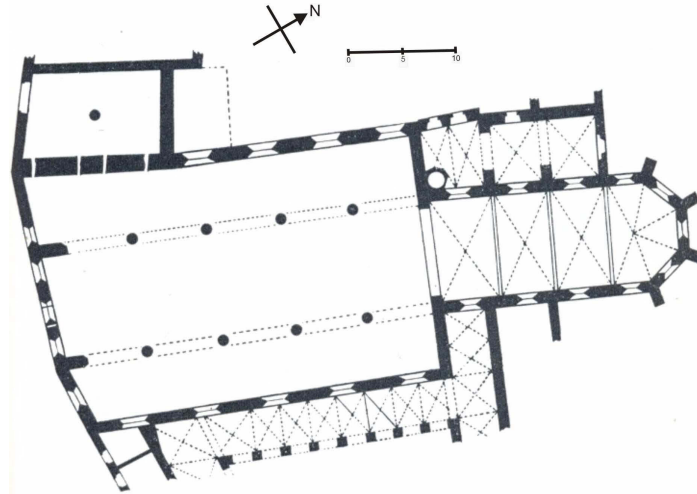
Grundriss der Dominikanerkirche.
